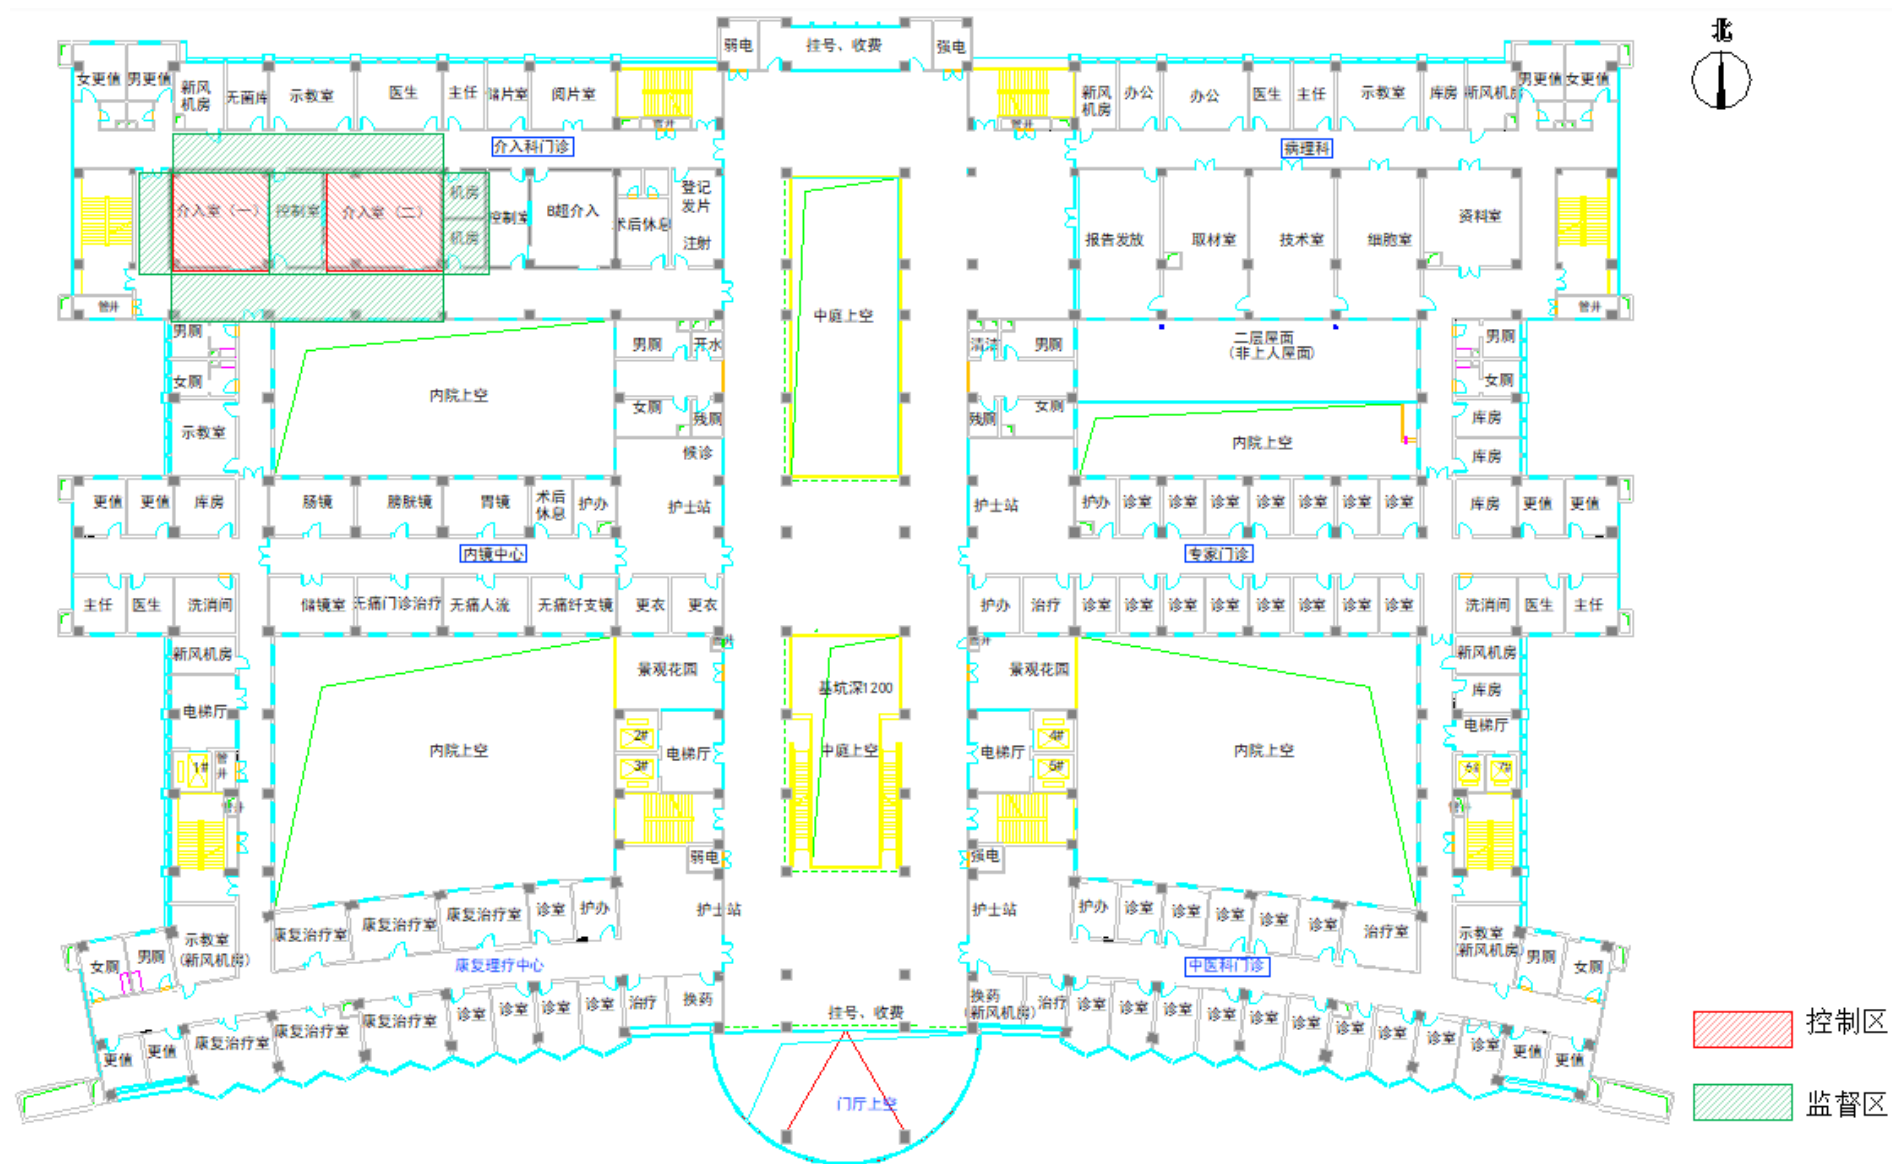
介入室（门诊医技综合楼三层）平面布置图
